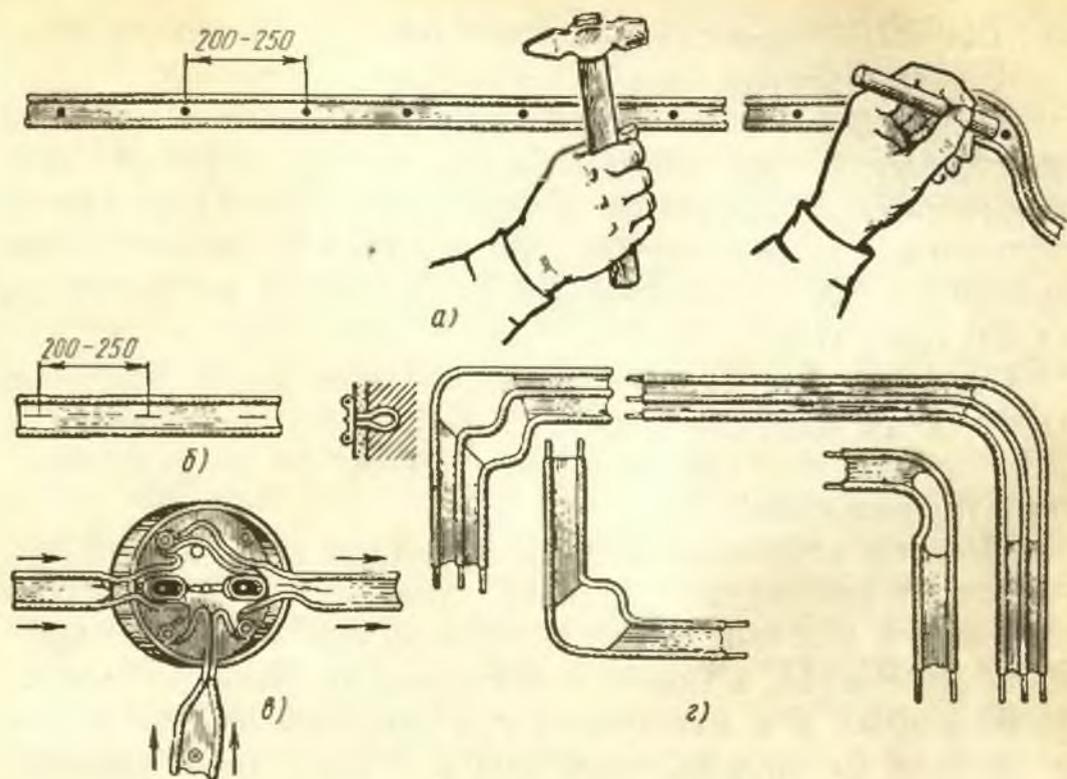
Монтаж открытой электропроводки плоскими проводами:
